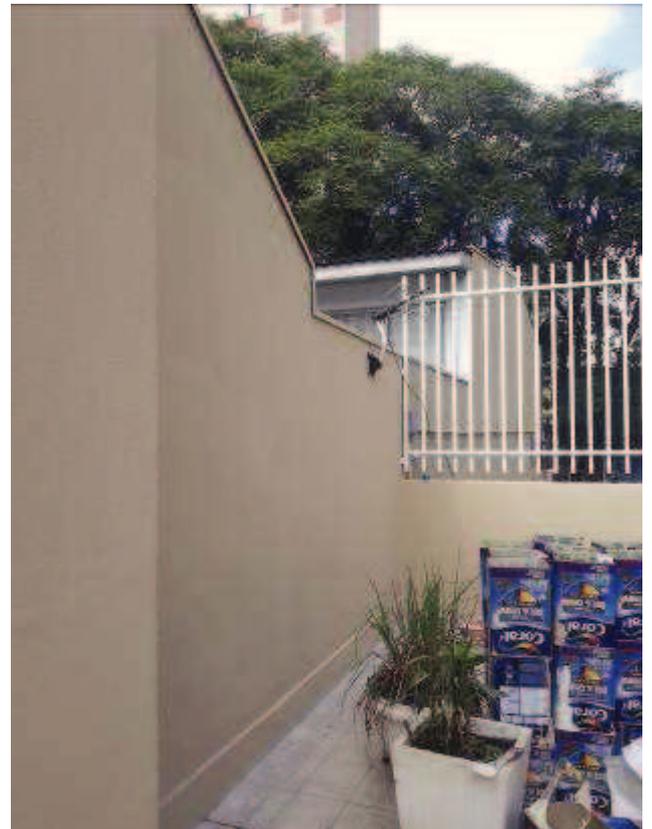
Reparo na parte inferior do muro. Na proteção da manta alfáltica
